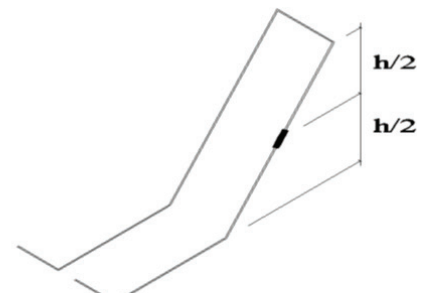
Posicionamento dos extensômetros nas armaduras de cisalhamento
